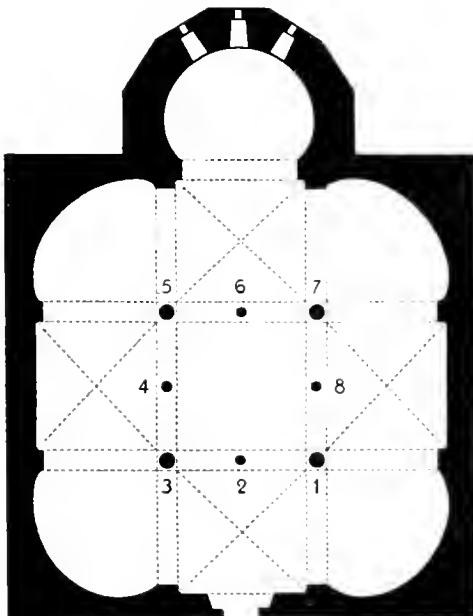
Plan del Baptisteri de Terrassa, Escala 1/200
